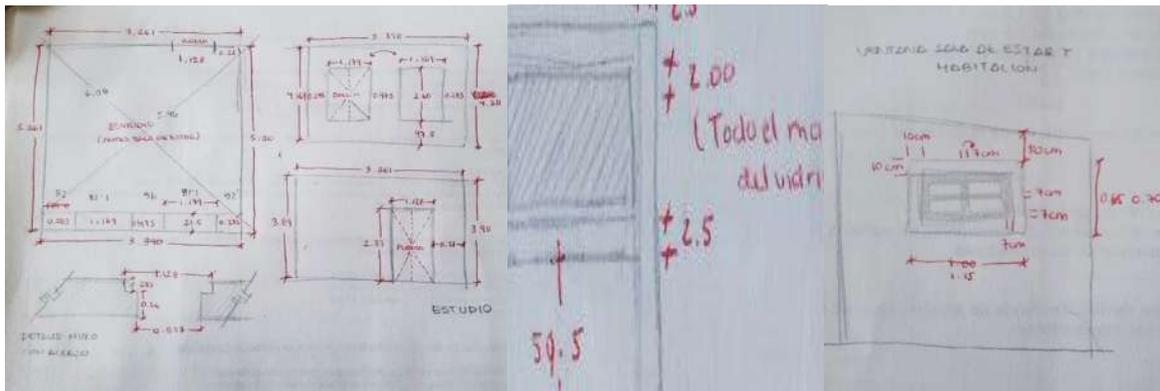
Croquis de planta, alzados, detalles de muros y complementos de carpentería. Elaborado por KNV.
